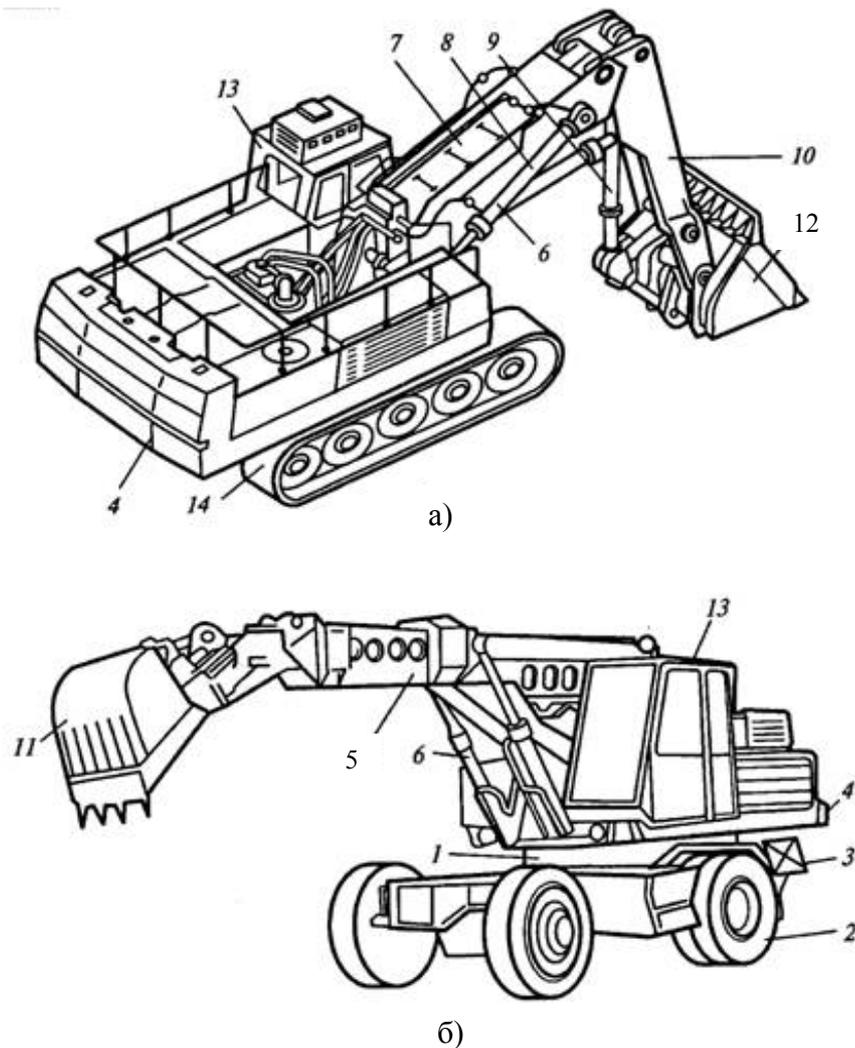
Одноковшовые гидравлические полноповоротные экскаваторы с жесткой подвеской рабочего оборудования: *а* – экскаватор, оборудованный прямой лопатой; *б* – экскаватор, оборудованный обратной лопатой; 1 – опорно-поворотное устройство; 2 – пневмоколесное ходовое устройство; 3 – выносная опора; 4 – поворотная платформа; 5 – телескопическая стрела; 6, 8, 9 – гидроцилиндры стрелы; 7 – стрела; 10 – рукоять; 11 – ковш обратной лопаты; 12 – ковш прямой лопаты; 13 – кабина машиниста; 14 – гусеничное ходовое устройство
